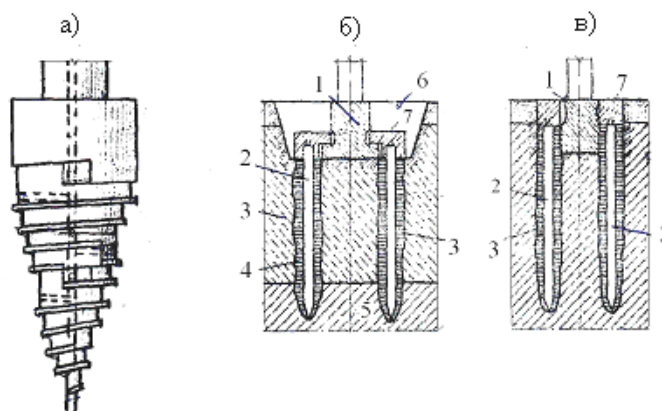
Усиление фундаментов набивными сваями, выполненными методом винтового продавливания:
